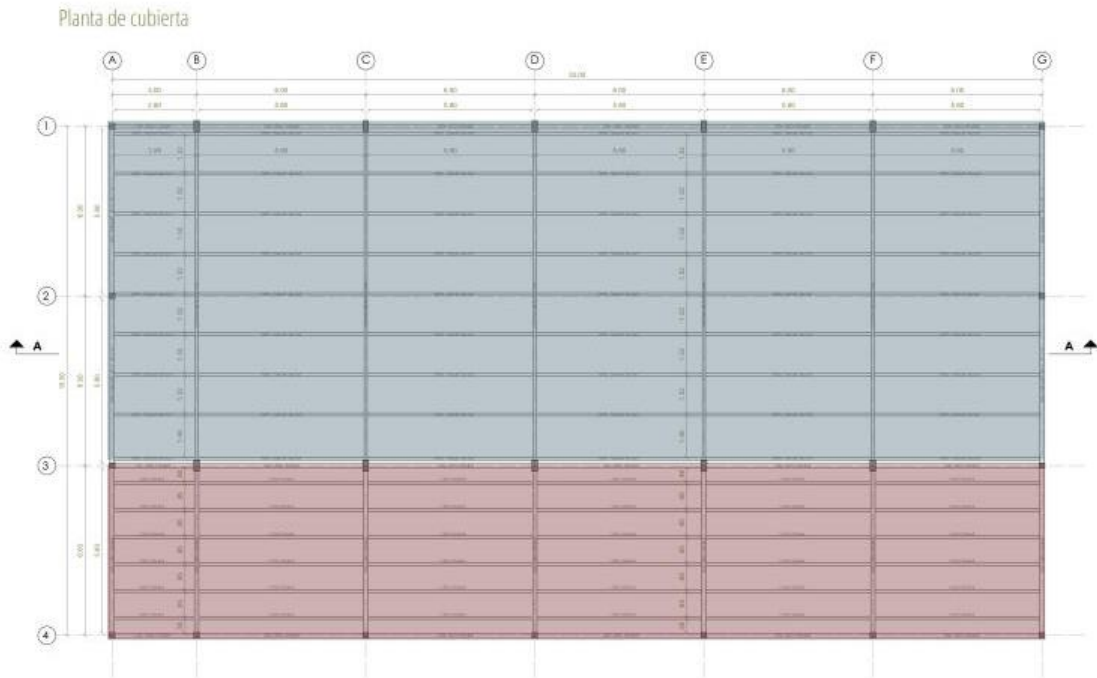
Cubierta bloque 1. Fuente: ilustraciones propias
